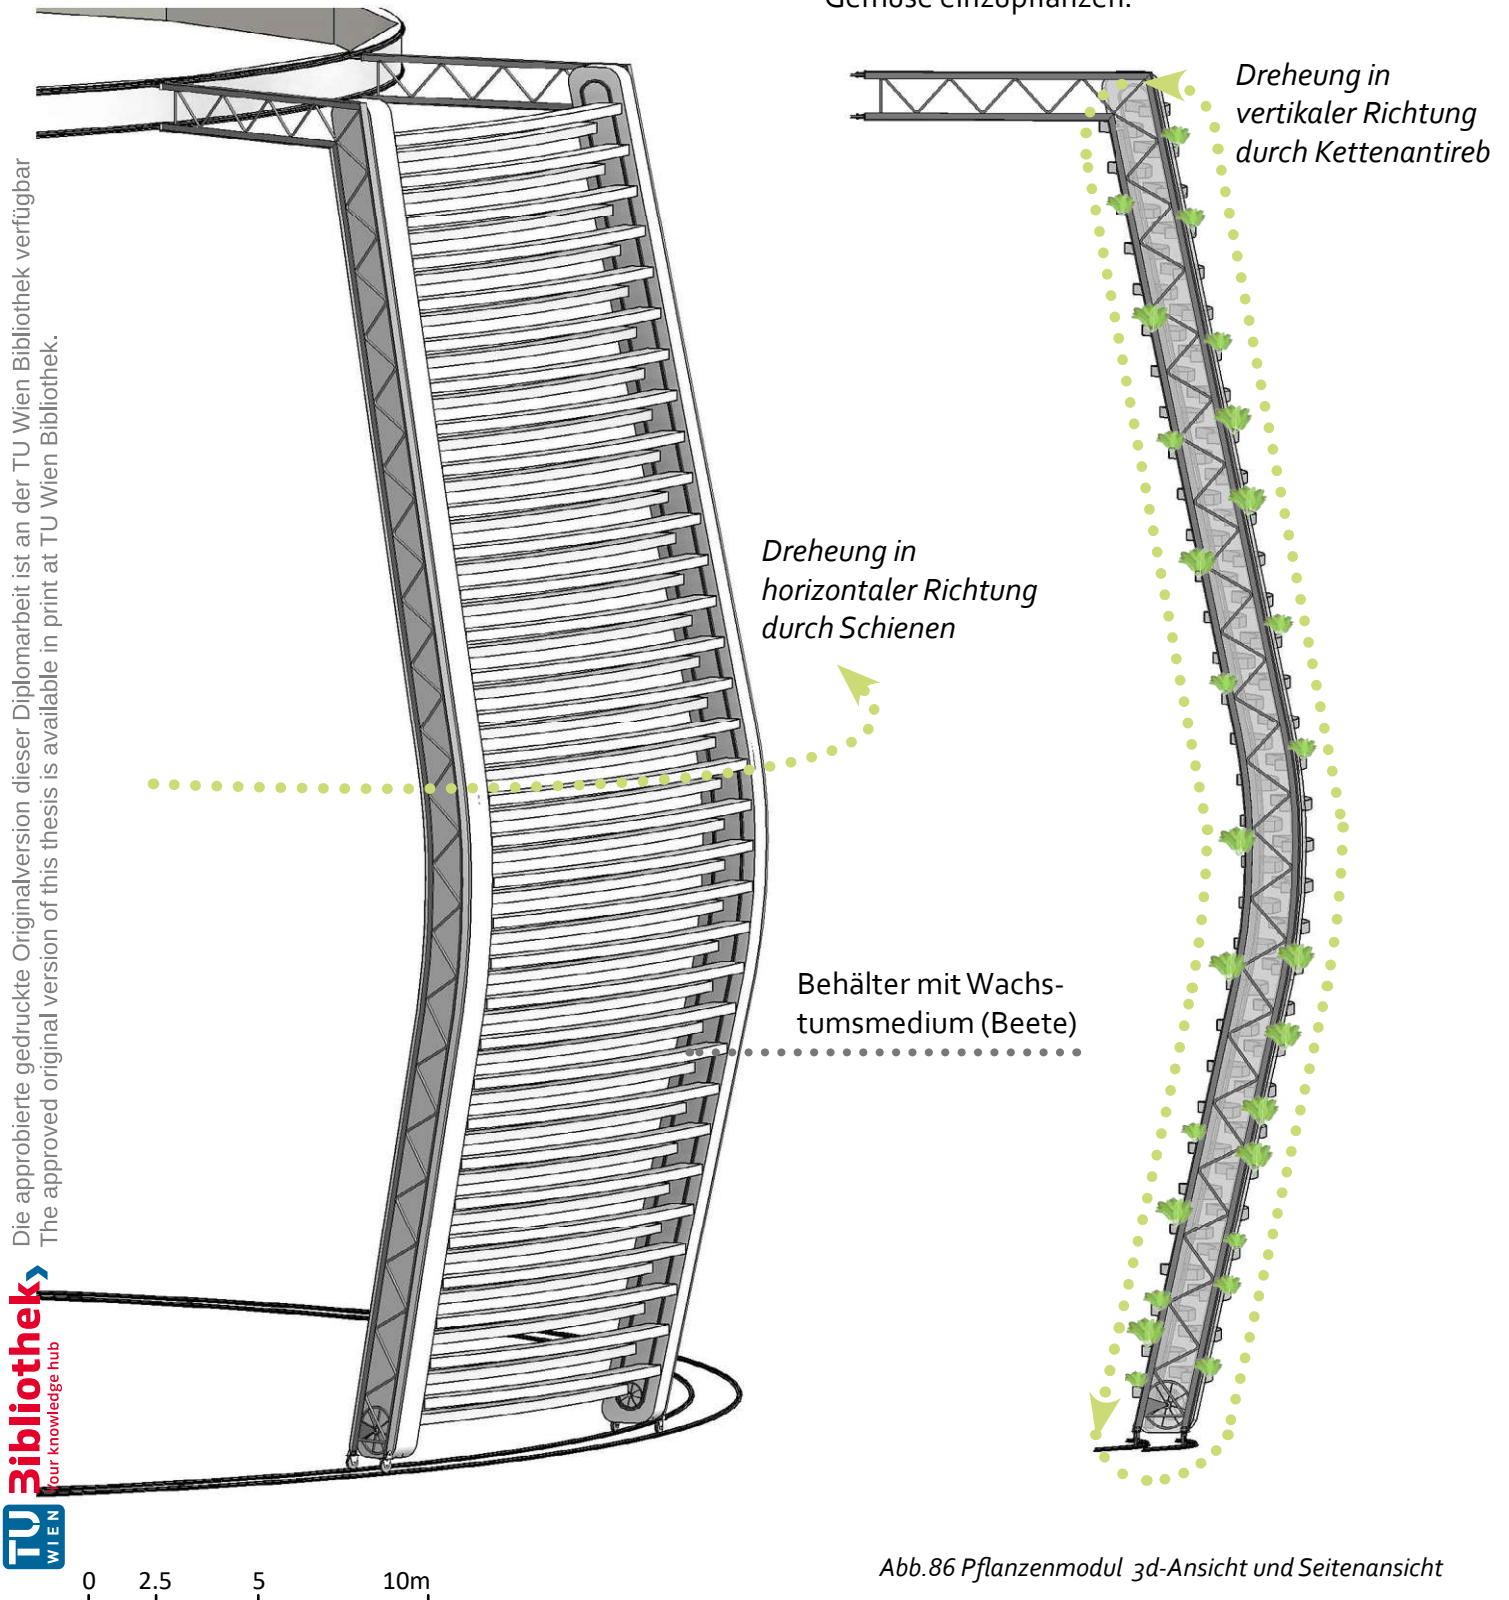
Pflanzenmodul 3d-Ansicht und Seitenansicht
